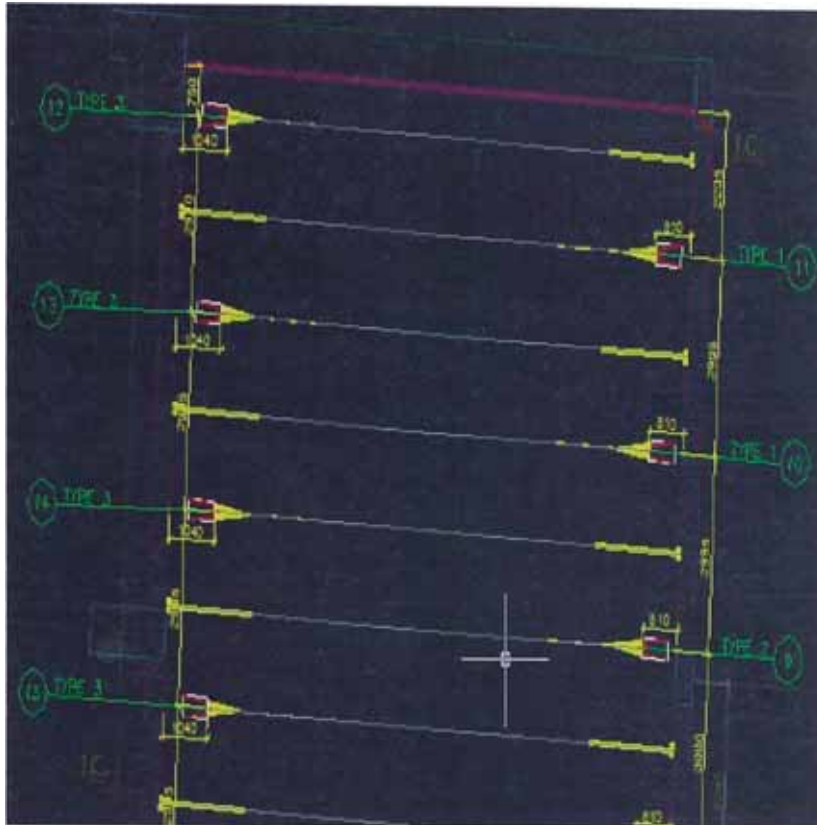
Planta de la losa postensada -Fuente: Planos de arquitectura del proyecto.
